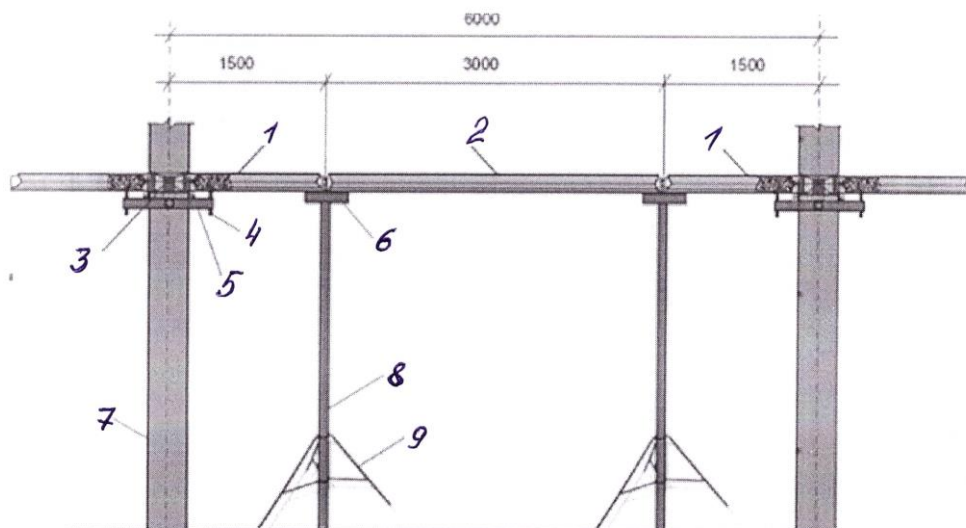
Схема монтажу плит перекриття: 1– надколонна плита; 2– міжколонна плита; 3 – кондуктор; 4 – опорний гвинт; 5 – збірний опорний столик; 6 – опора; 7 – колона; 8 – стійка; 9 – тринога.
